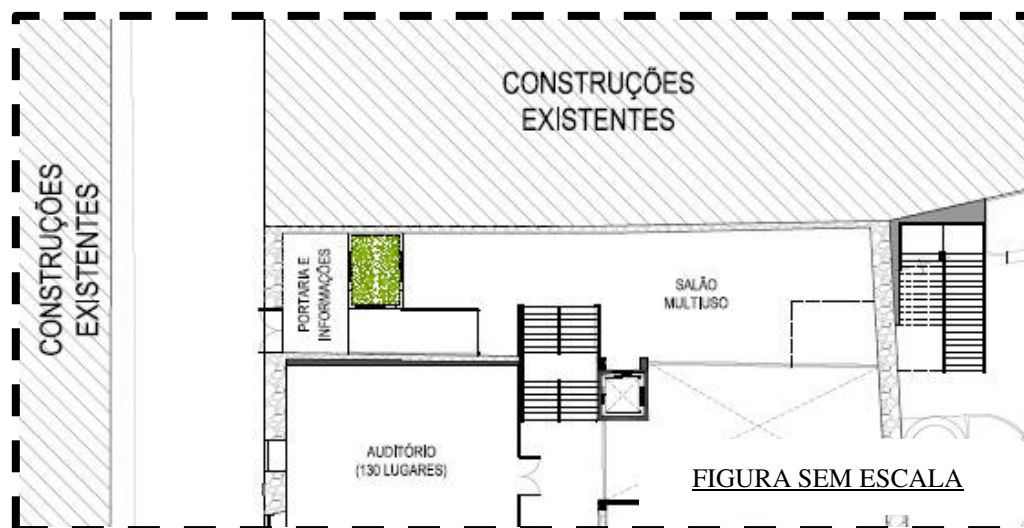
Proposta de intervenção no pavimento anexo dos fundos
